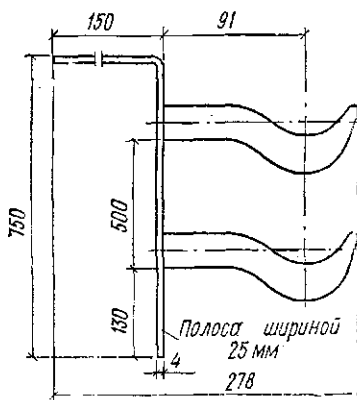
Кронштейн двойной типа 11кс (масса 0,94 кг) для крепления радиаторов на бетонных подоконниках дюбель-гвоздями
